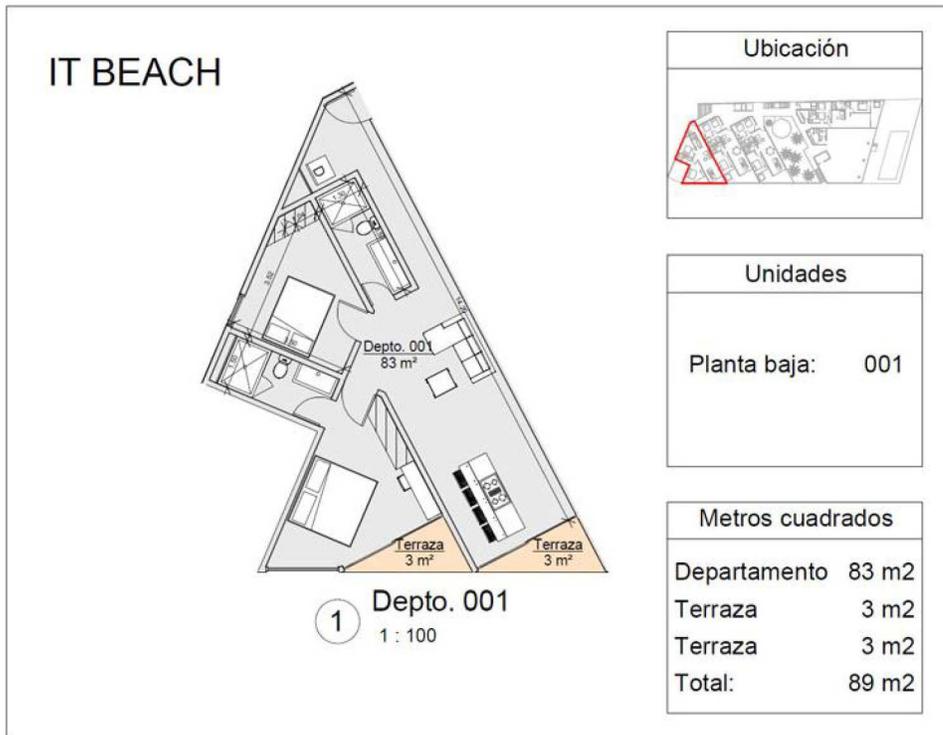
Distribución de los componentes de los departamentos con vista a la Calle Albatros en planta baja.
